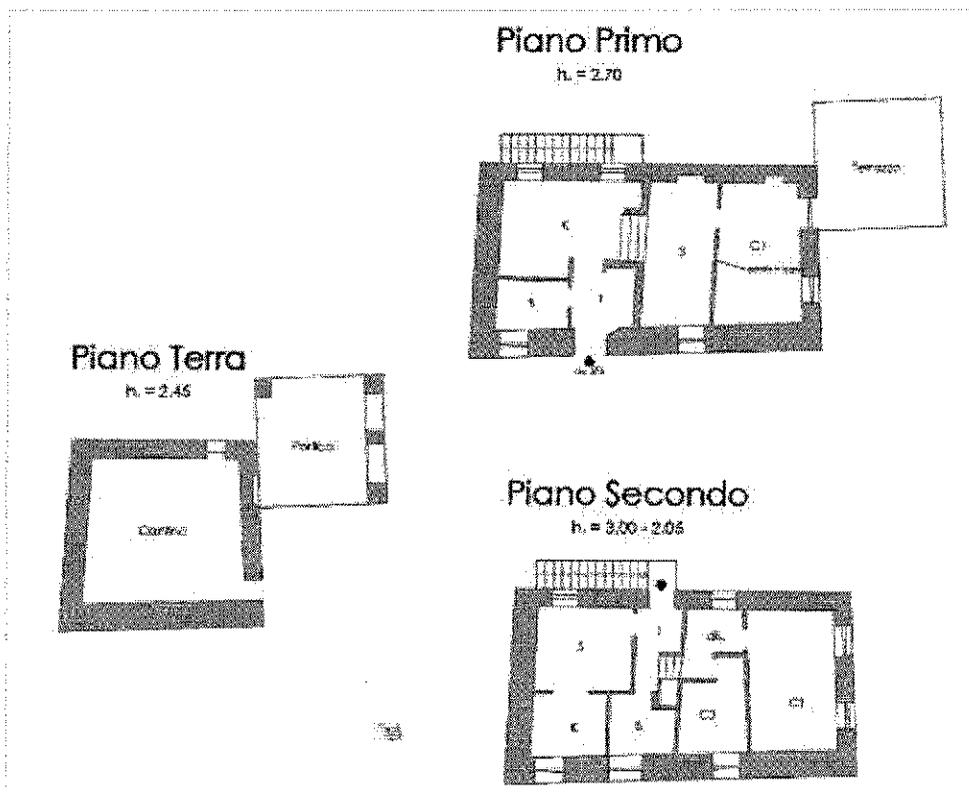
Stralcio planimetria immobile e identificazione locali appartamento oggetto di stima
